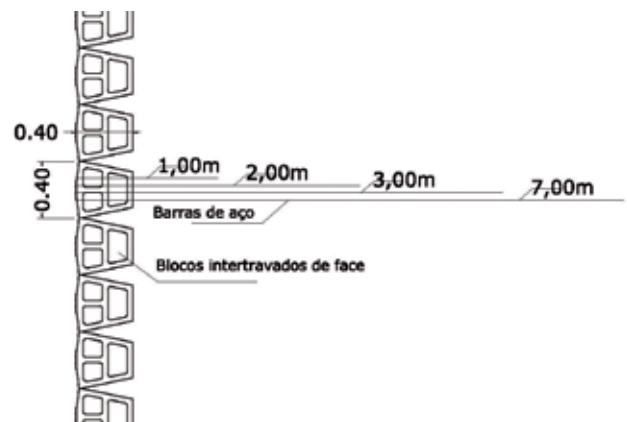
Vista em planta do posicionamento das barras de aço utilizadas como *tell-tales
